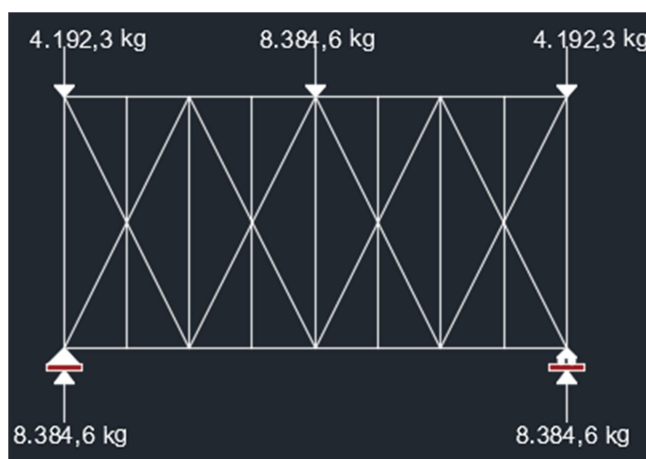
Esquematización de los esfuerzos en los arriostramientos de cubierta
